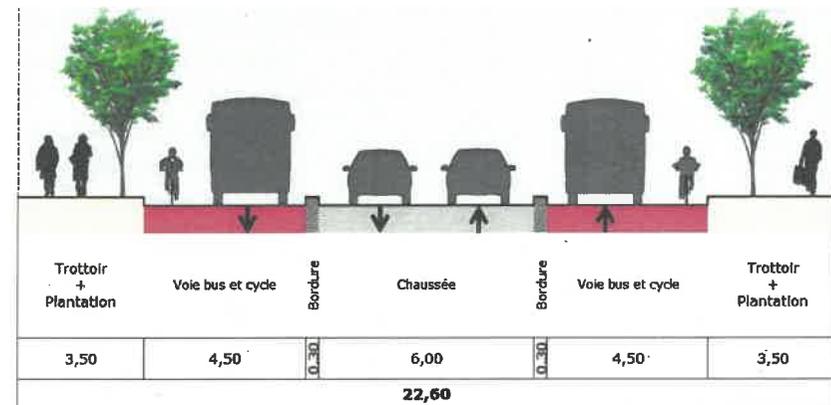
Coupe type pour l'insertion d'un site propre bilatéral
